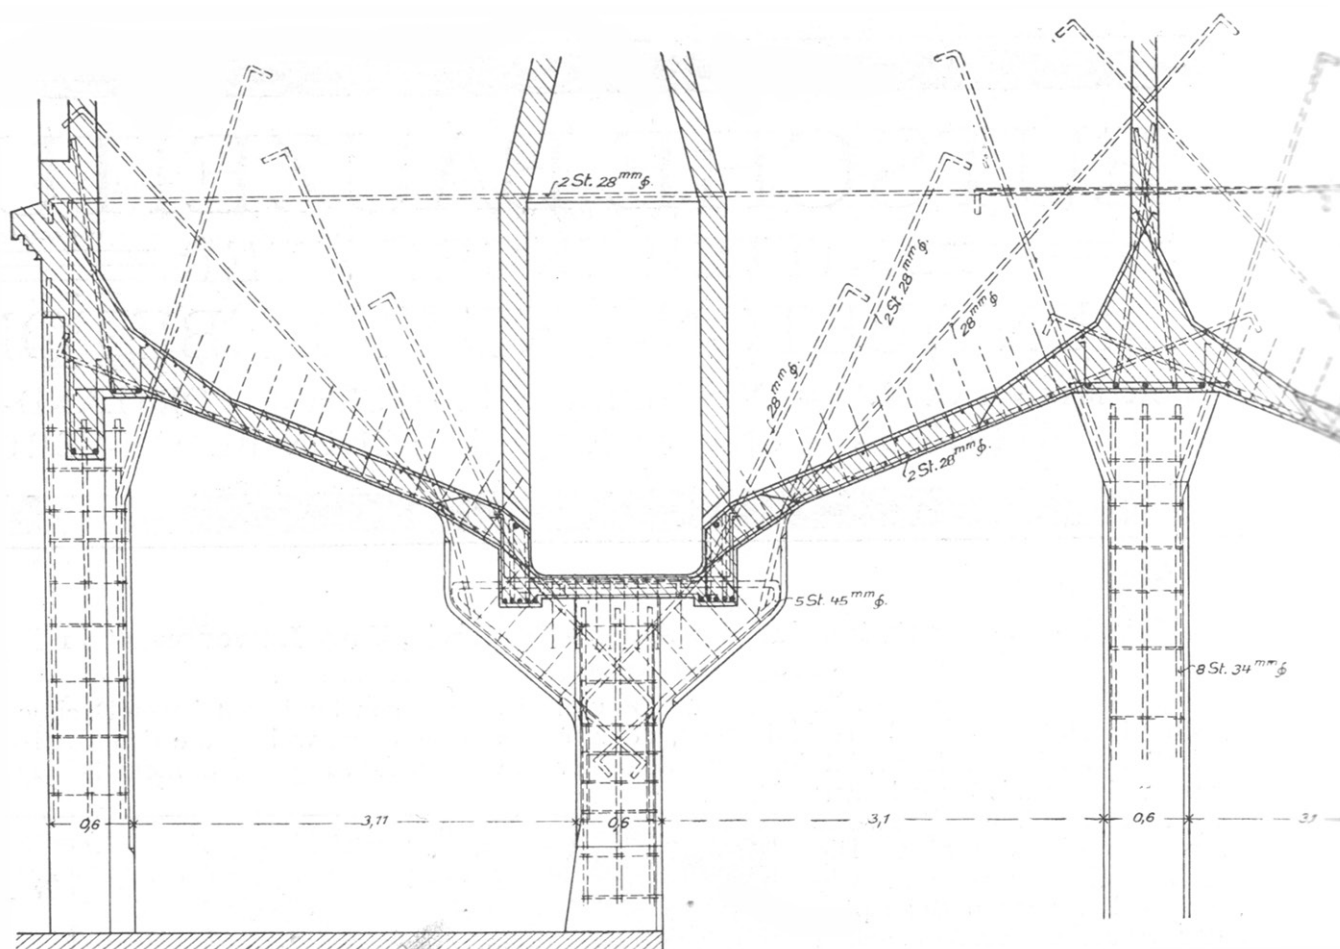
Bewehrungsplan der Eisenbeton-Gesellschaft m.b.H (DBZ 1905, S. 42).
